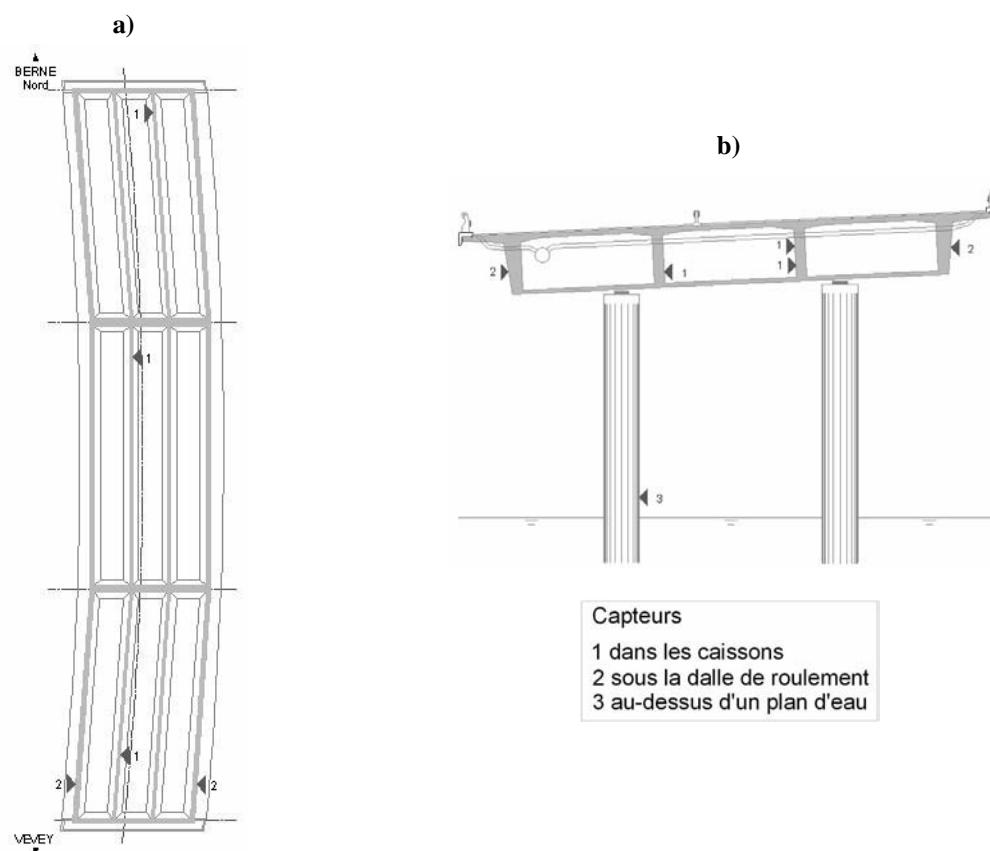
Disposition des capteurs sur le pont sur la Denève, a) vue en plan, b) profil en travers [Nendaz02].
